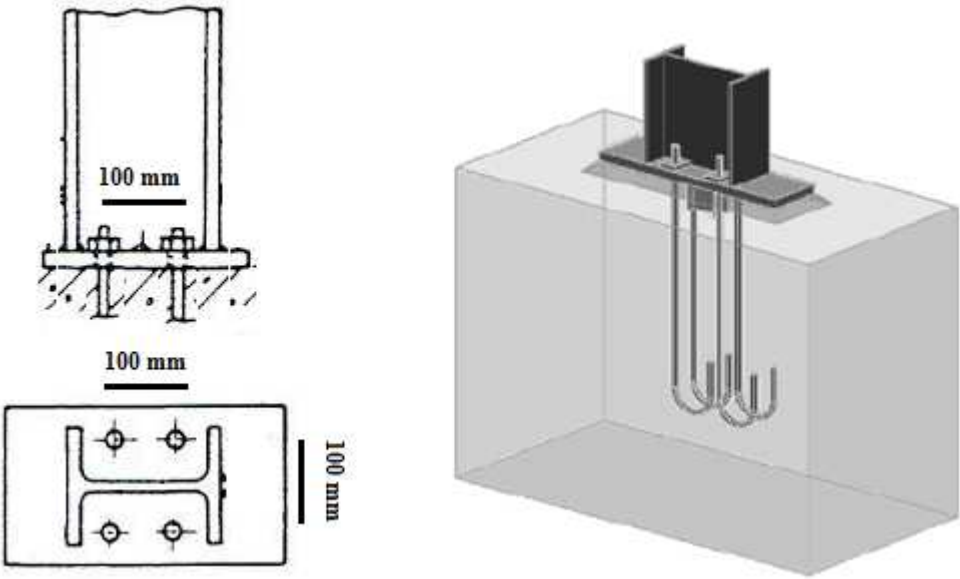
Pied de poteau articulé avec 04 boulons d’ancrage
